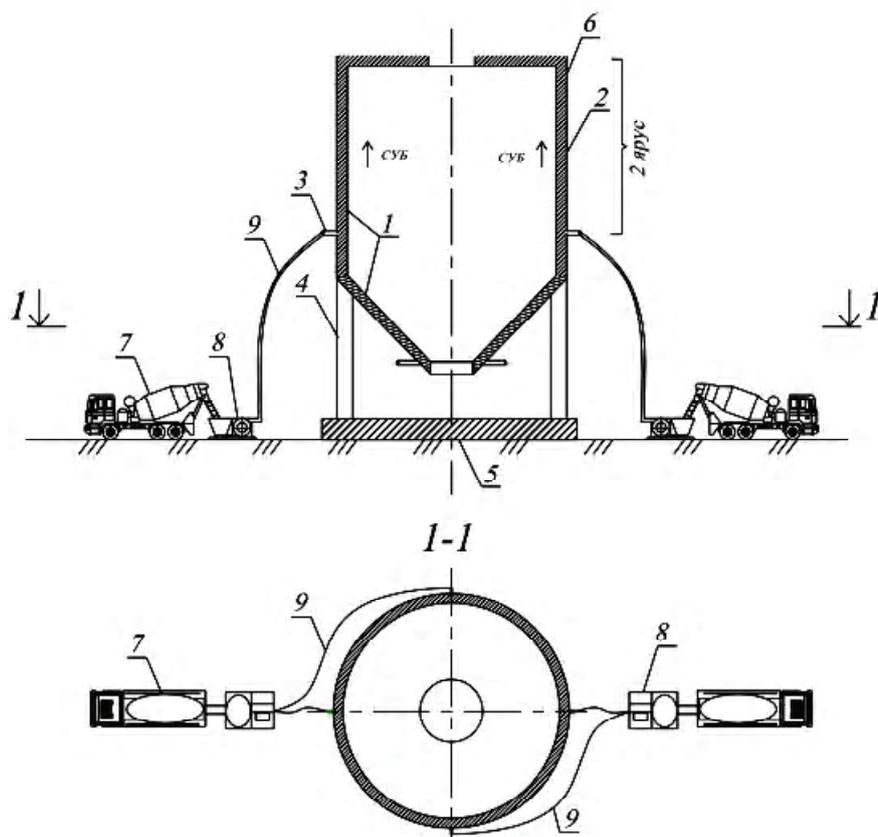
Бетонирование 2-го яруса бункера: 1 – внутренняя опалубка; 2 – наружная опалубка; 3 – штуцеры для подачи бетона; 4 – колонны; 5 – фундамент; 6 – самоуплотняющийся бетон 2-го яруса; 7 – автобетоносмеситель; 8 – роторный насос; 9 – шланг для подачи бетона.
